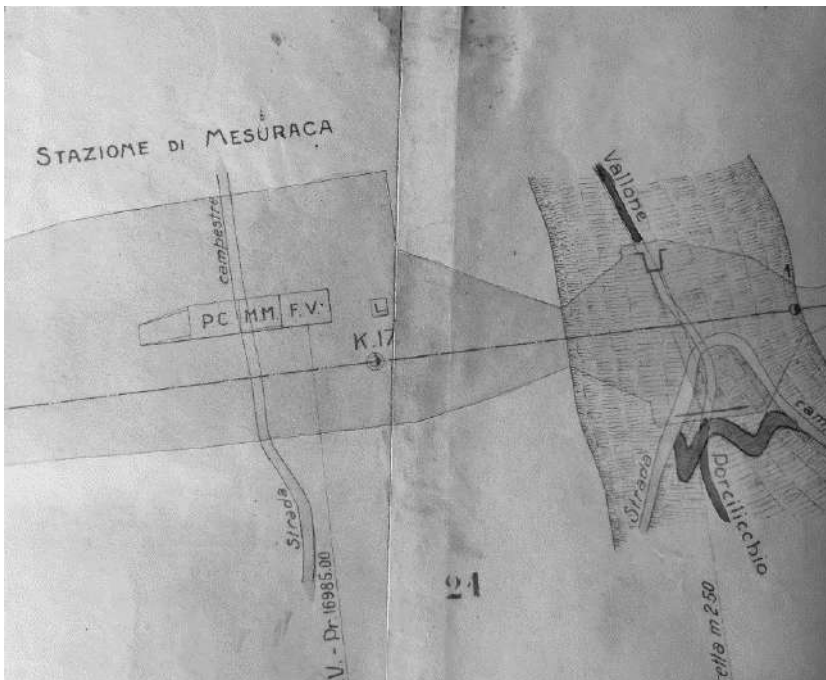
Piano di esecuzione di esproprio, Stazione di Mesuraca
